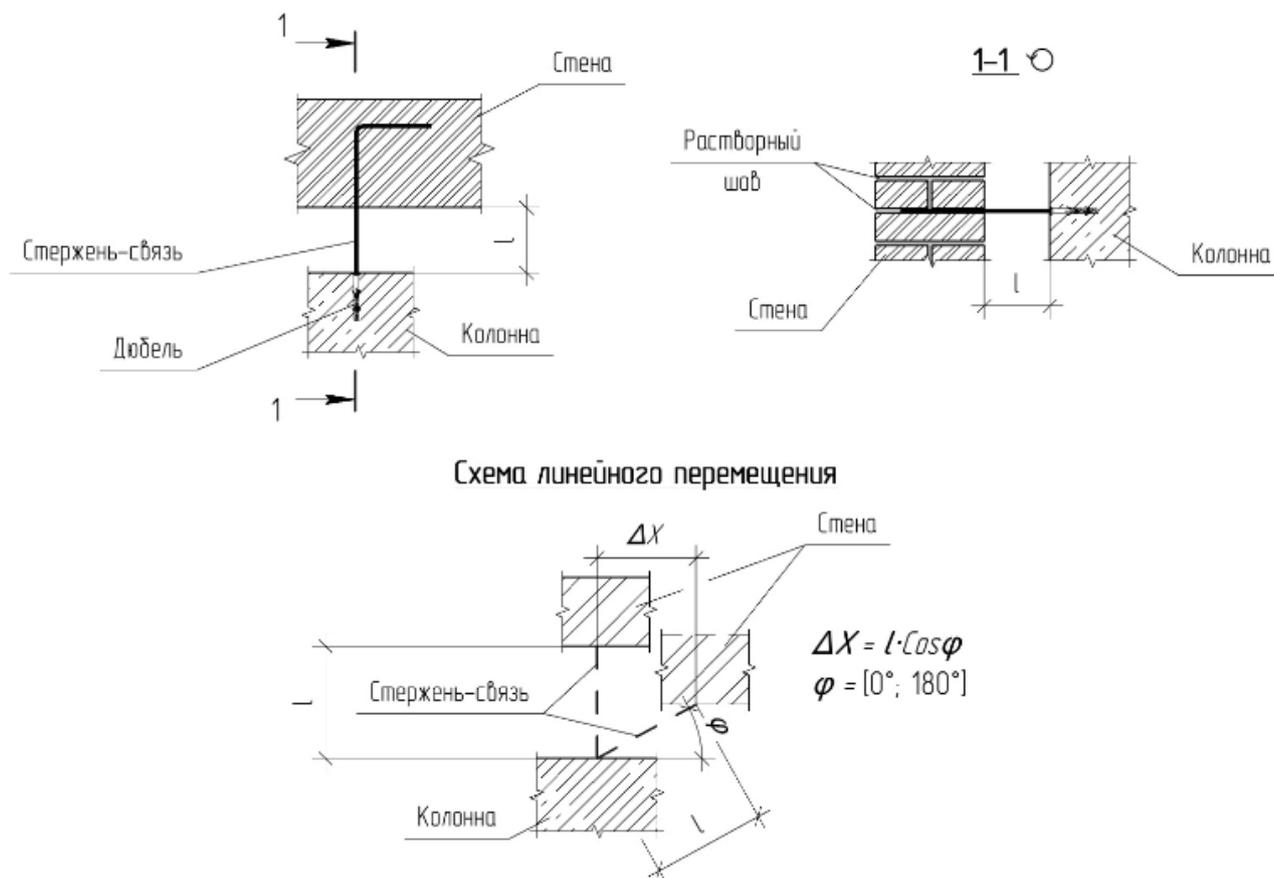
Гибкая связь между колонной и стеной на примере стержня
